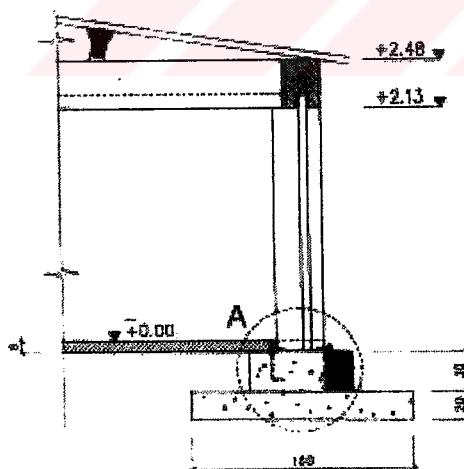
Yan görünüş (Set Betoya, 1999)
